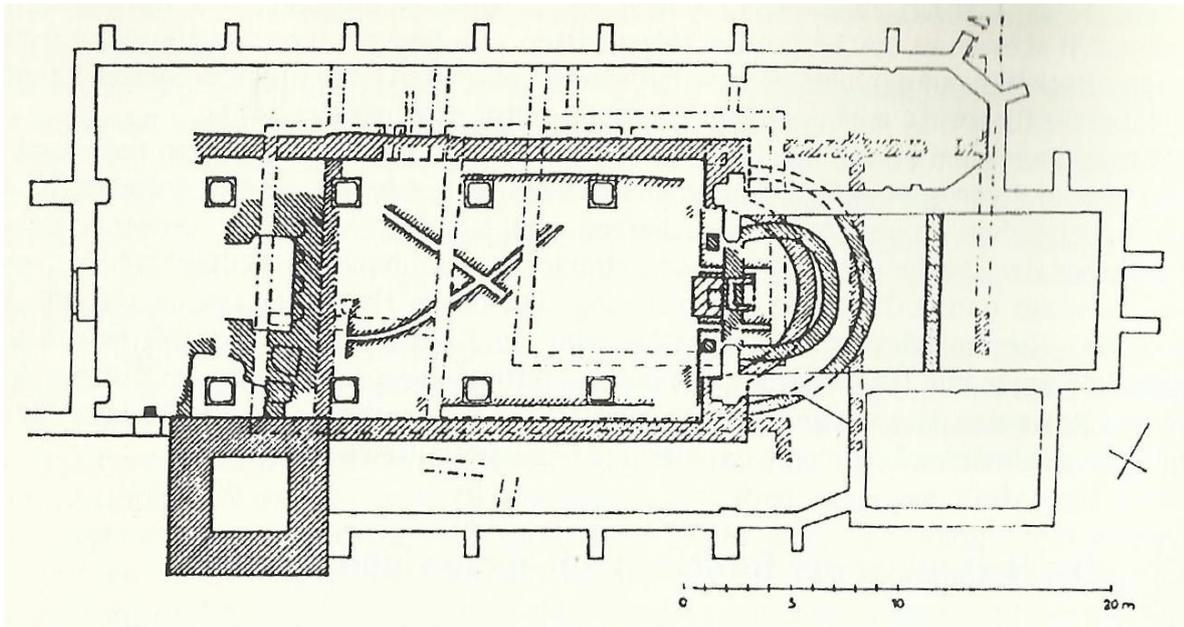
Grundriss der Reste der Kanalheizung von Lauriacum (Aus: Bingenheimer, 1998, S. 42.)
